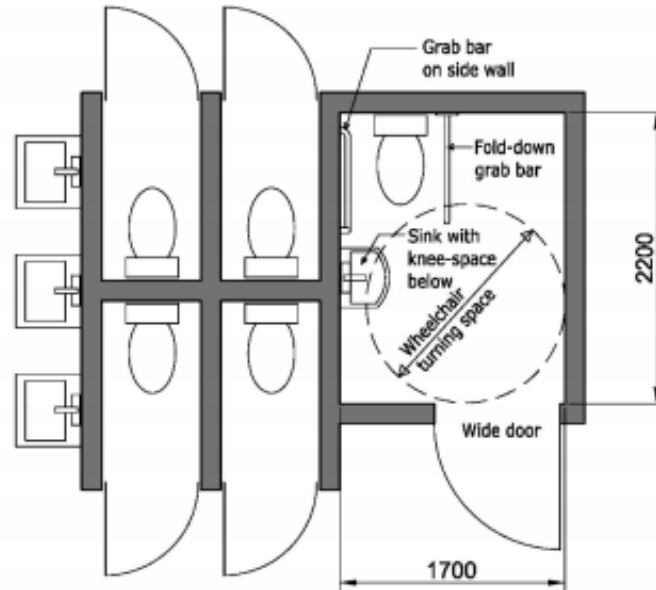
Plan de blocs de toilettes avec des installations accessibles en fauteuil roulant, Source : GAATES, Bob Topping.
